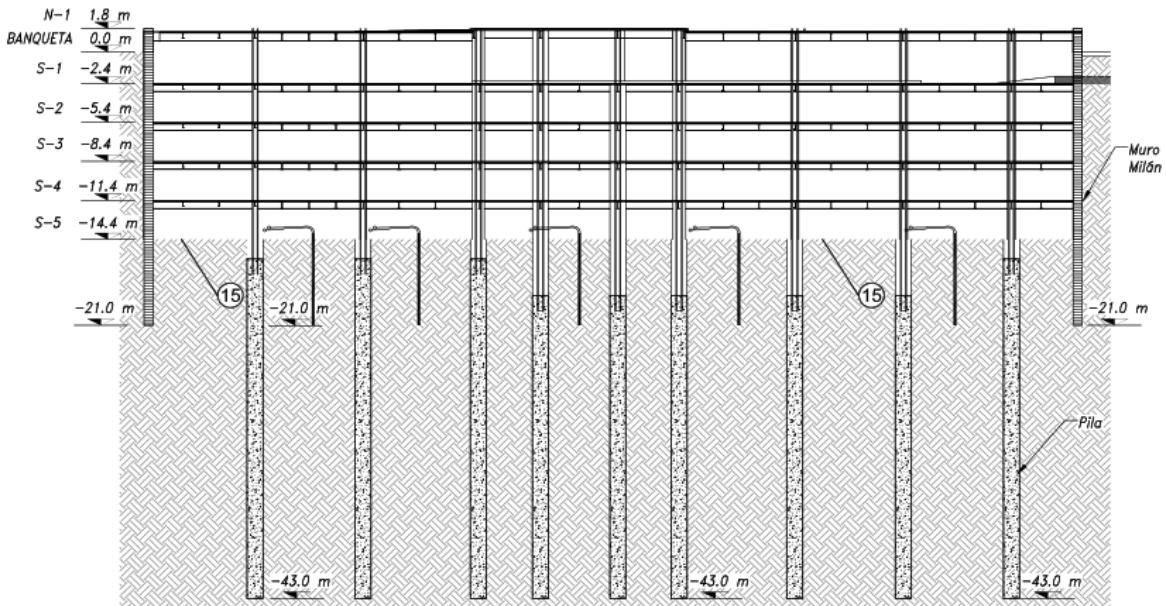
Proceso constructivo Top-Down – Etapa 15. Fuente: Cortesía del proyecto Marina 385
